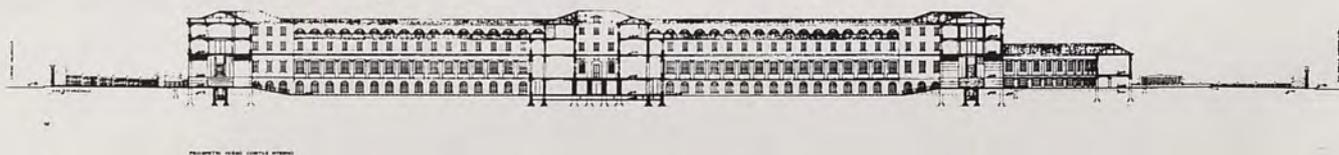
i - Il progetto di ristrutturazione: prospetto verso il cortile interno.
